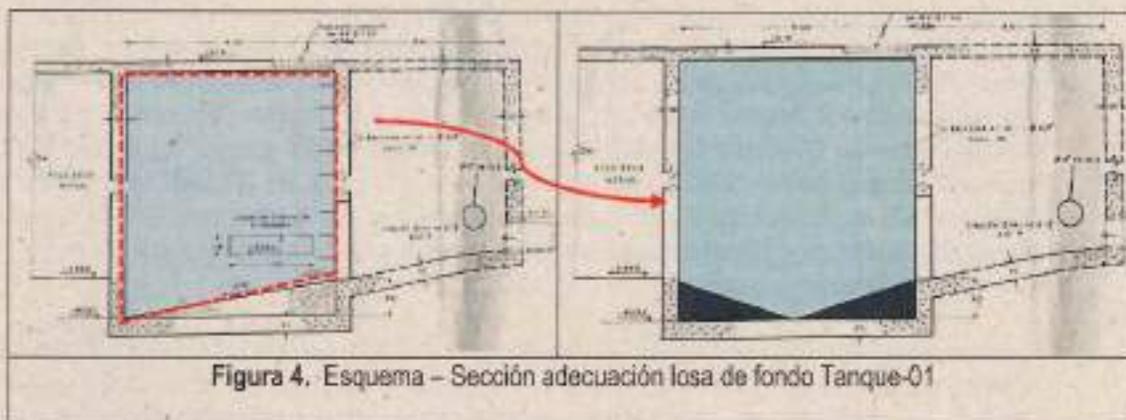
Esquema - Sección adecuación losa de fondo Tanque-01
